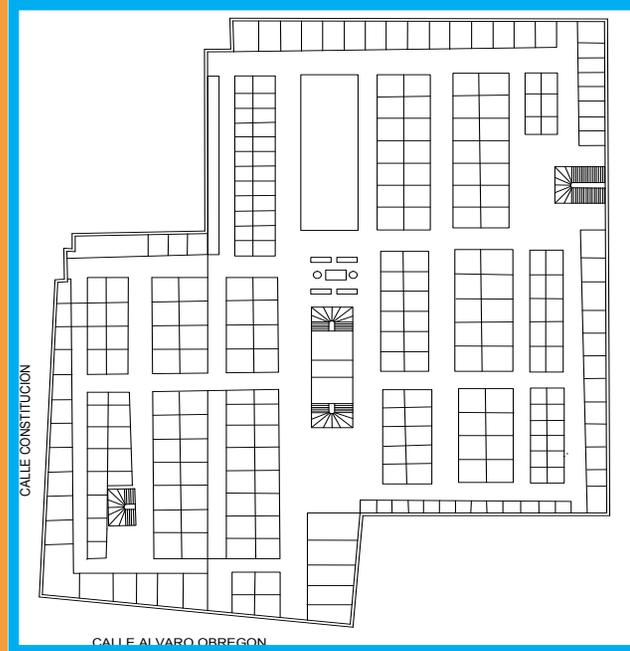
Planta del mercado Tariacuri nivel 2
